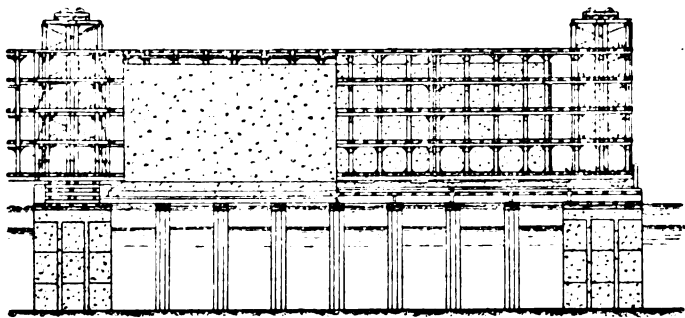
Cantiere per la costruzione dei blocchi. - Elevazione.
